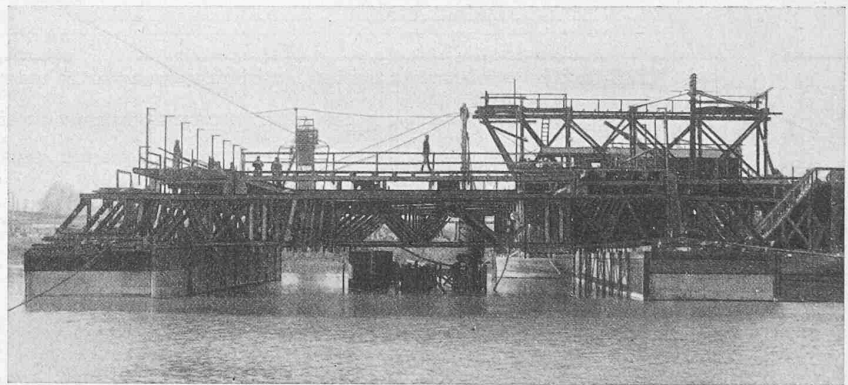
Schwimmergerüst des beweglichen Caisson.
